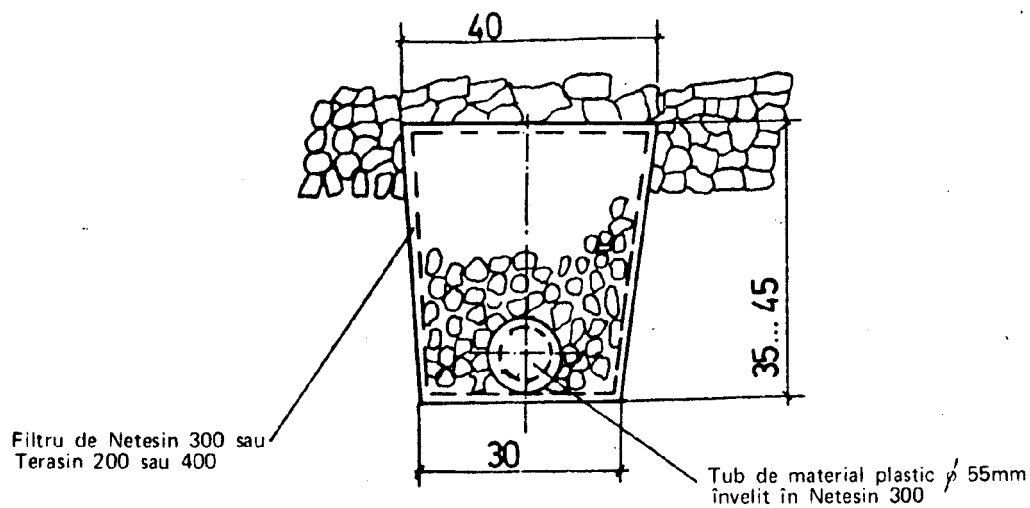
Dren cu corp drenant de pietriș și filtru geotextil
